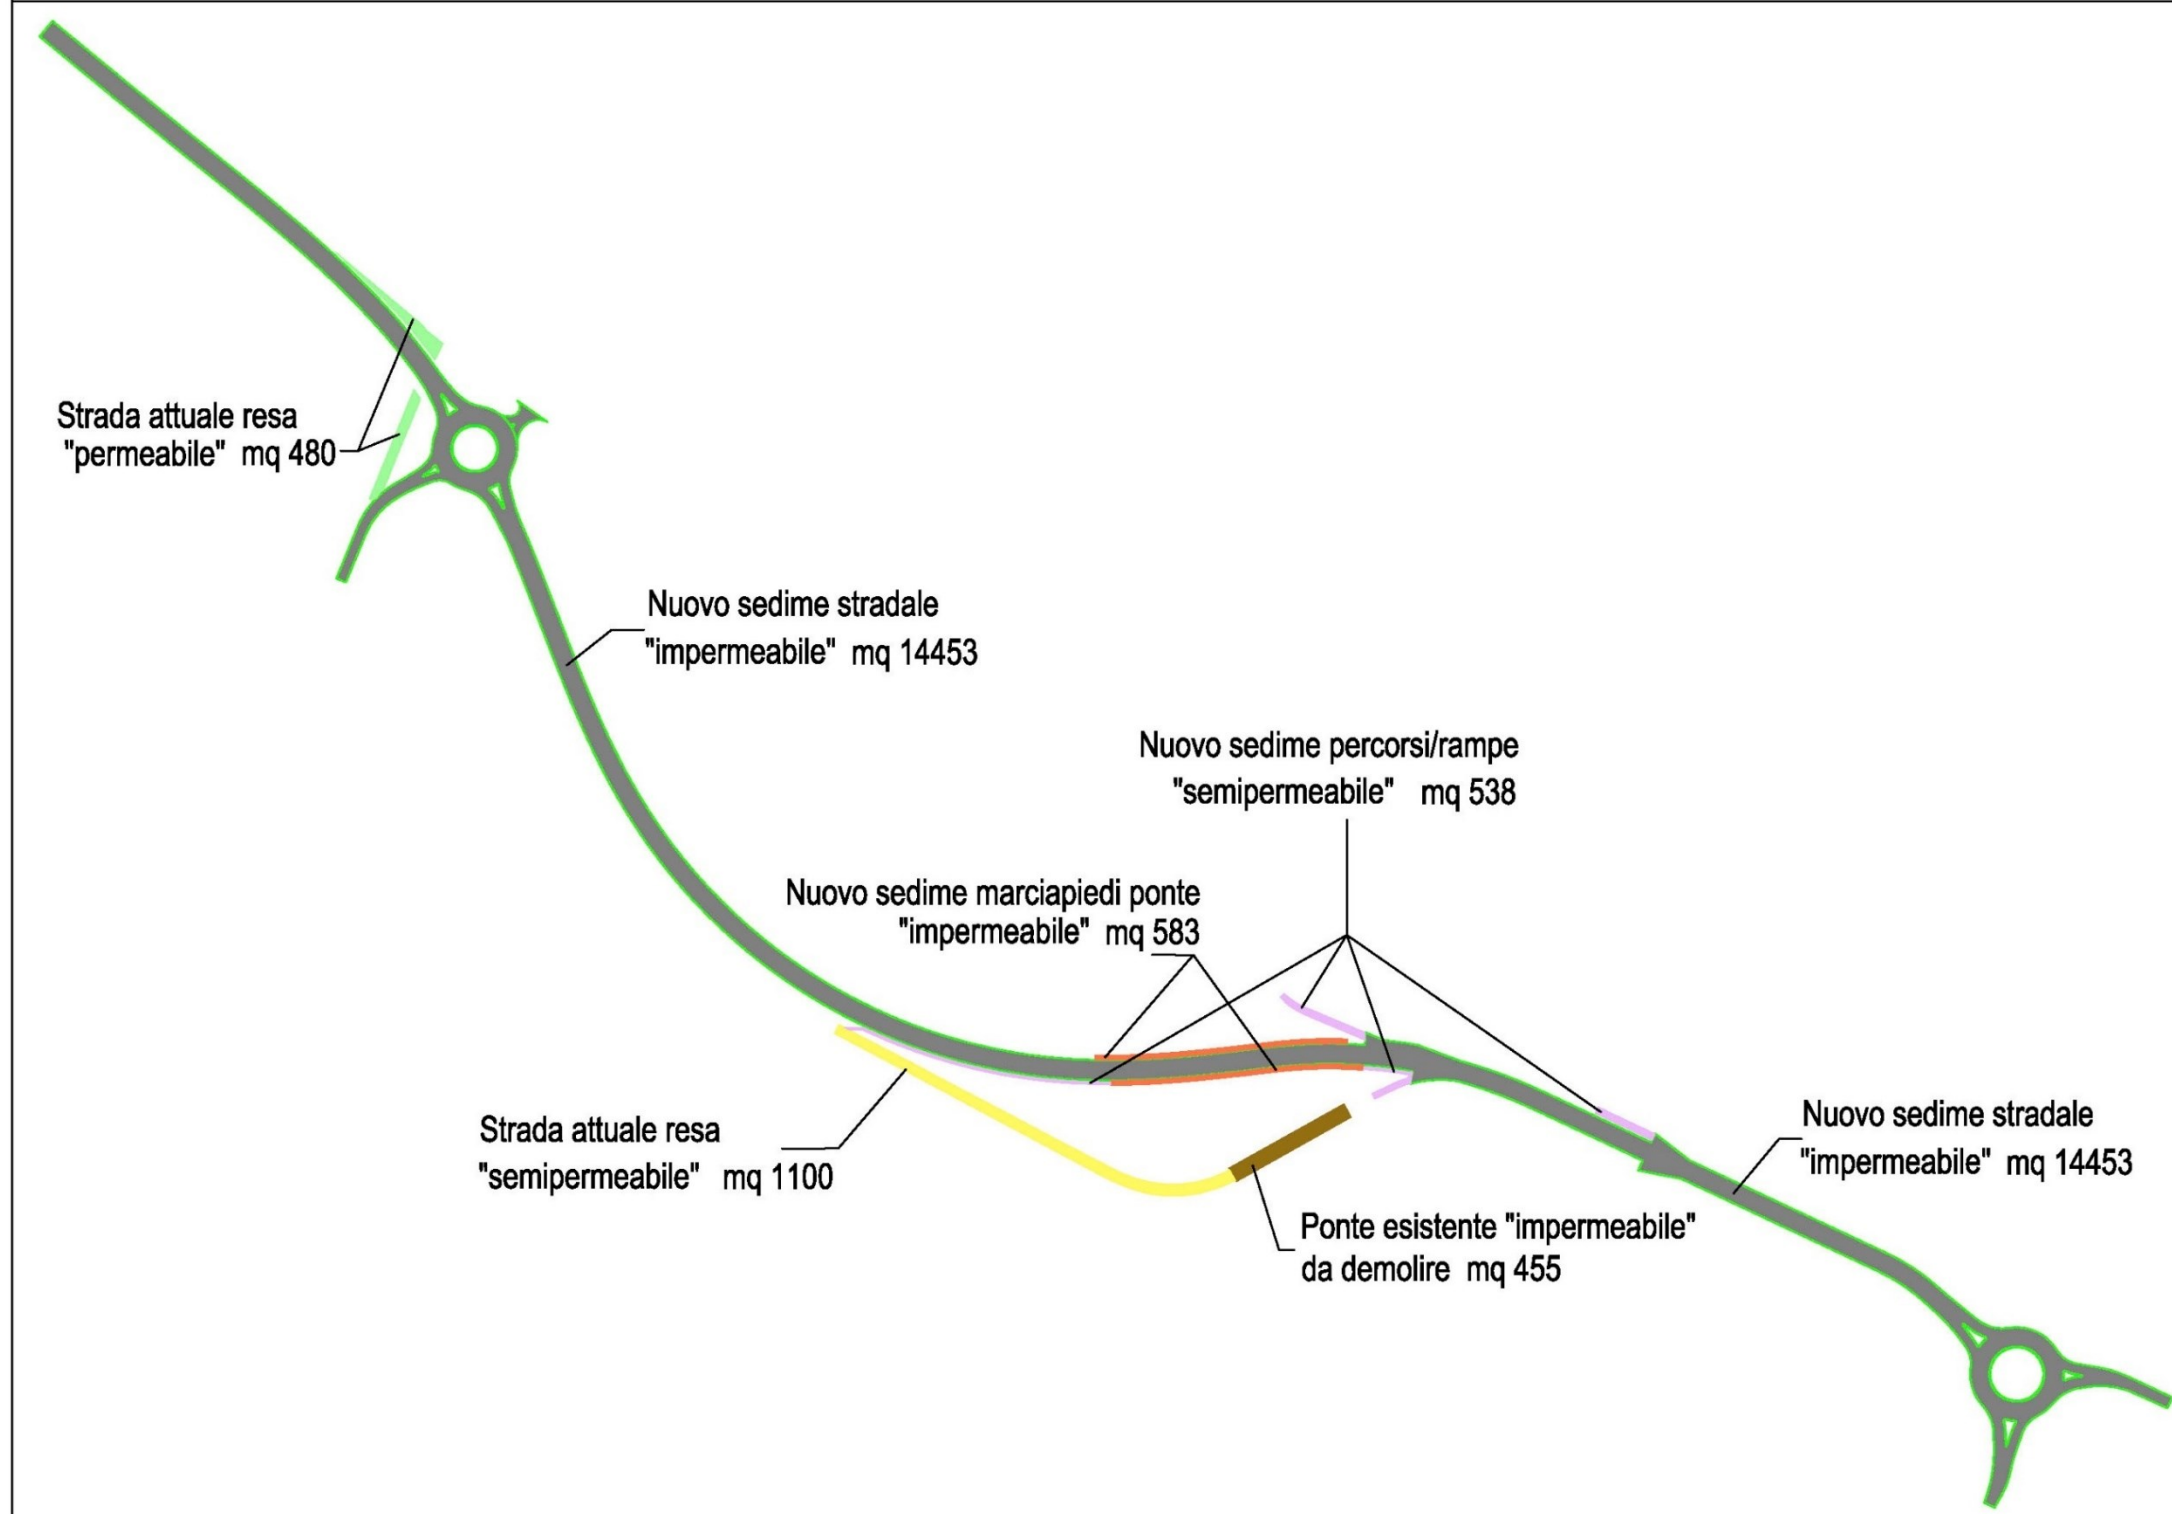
Schema planimetrico delle superfici impermeabili, semipermeabili ed impermeabili nello stato di progetto
